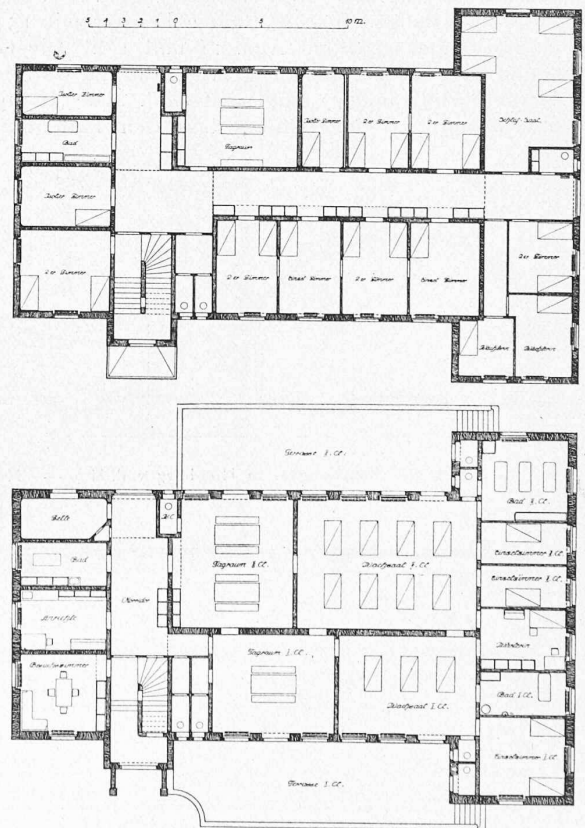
und 10. Pavillon für Unruhige. — Masstab 1 : 400.
